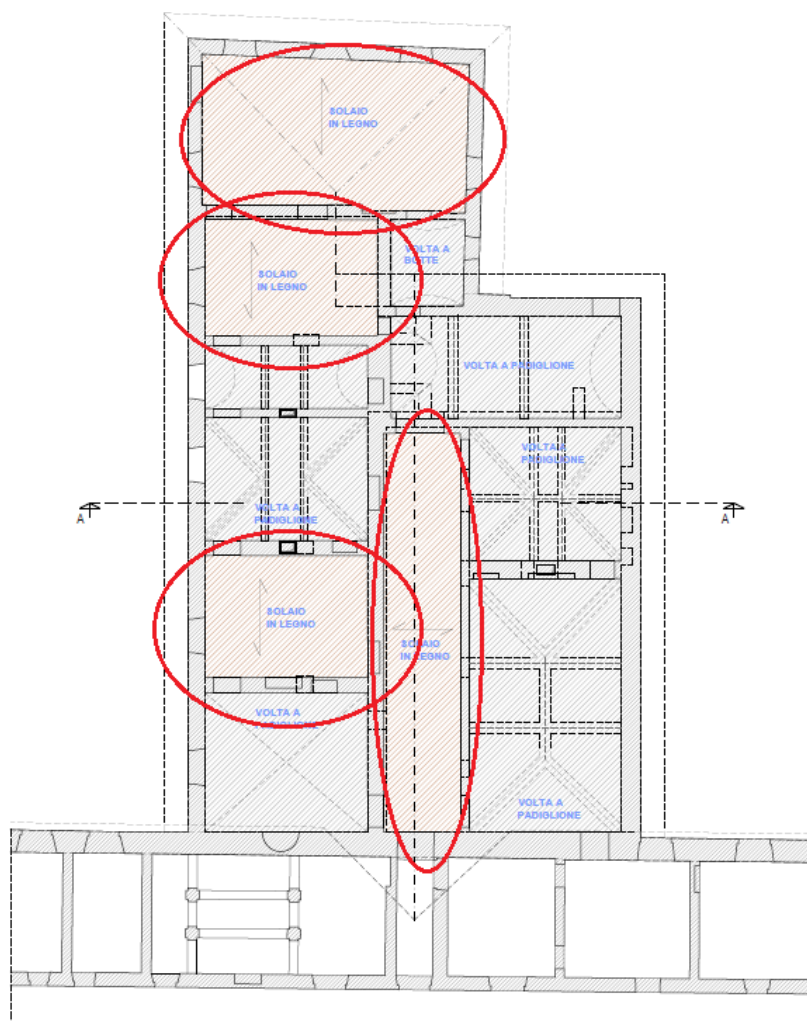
Individuazione in pianta con individuazione dei solai lignei di sottotetto nella stanza in prossimità del pozzo. È la zona più deteriorata a causa delle infiltrazioni delle acque meteoriche.
